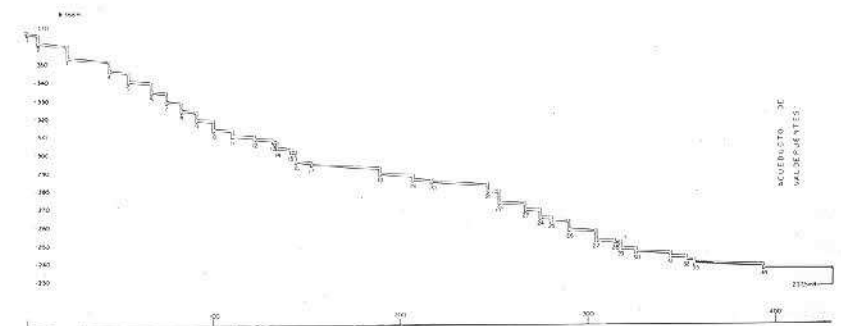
Perfil longitudinal del sistema de pozos de resalto. Según López-Cuervo.
